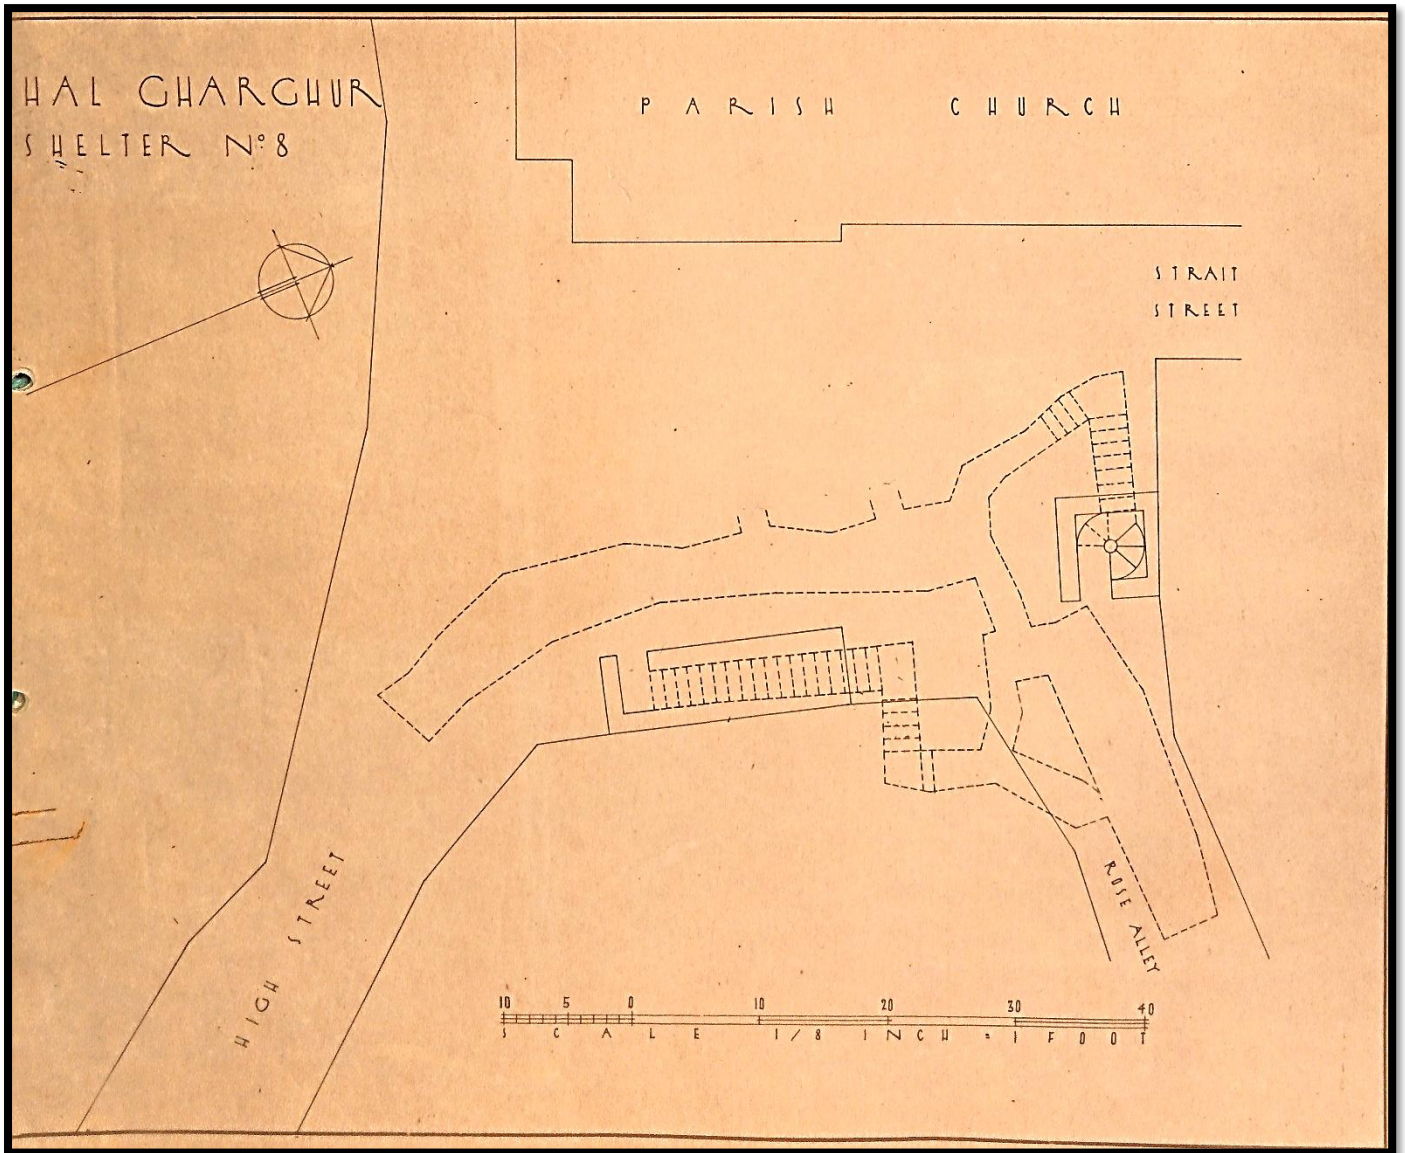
Planta do Abrigo nº8 "High Street – Strait Street."
